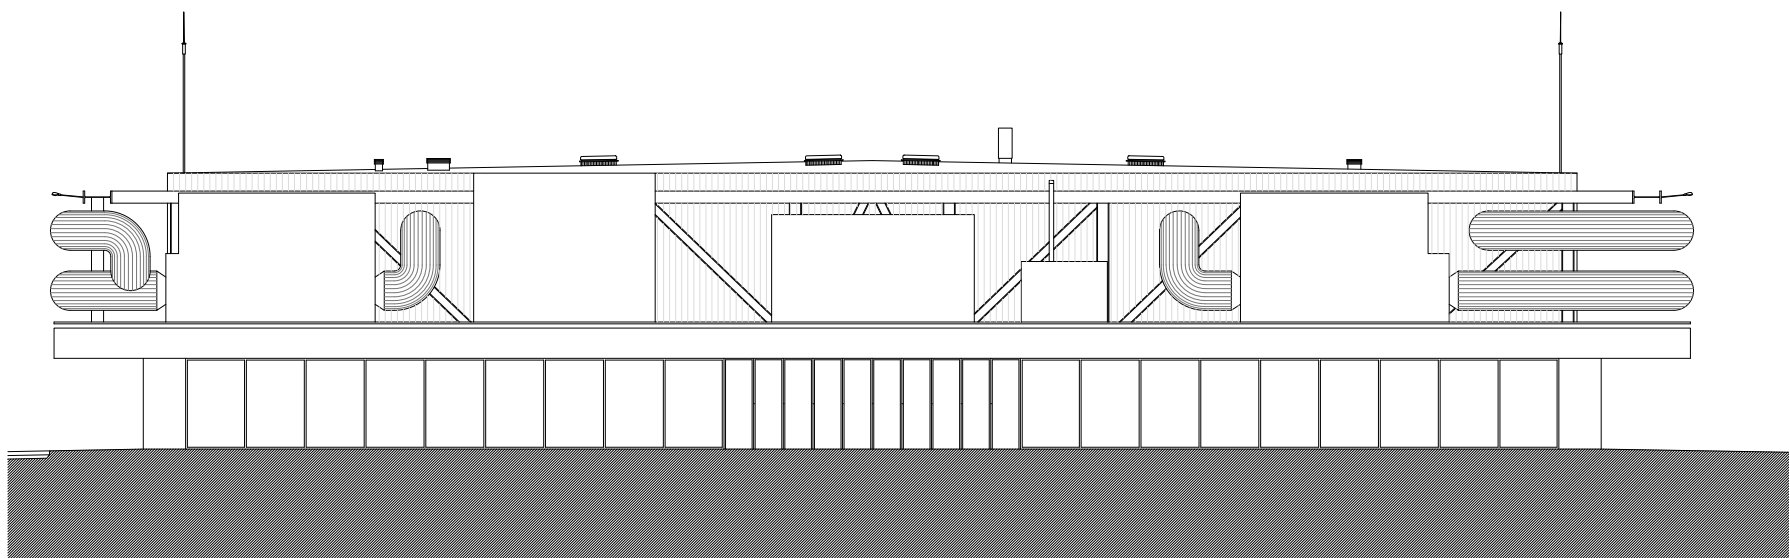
Alzado leste do Centro Cultural. Escala 1/250.
